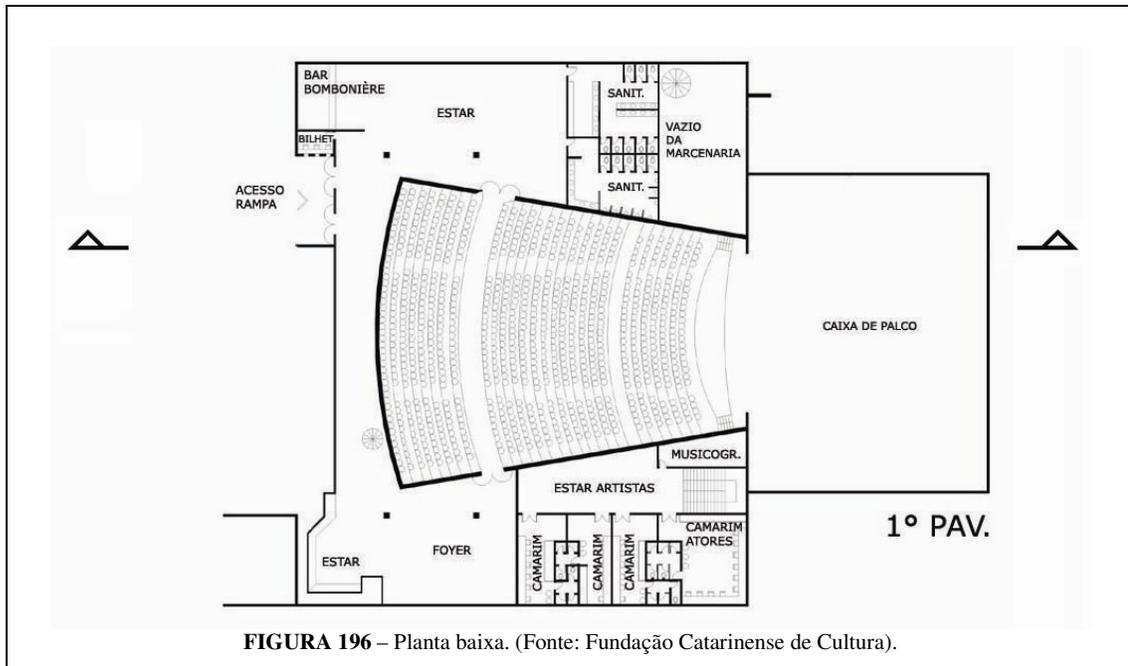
Planta baixa. (Fonte: Fundação Catarinense de Cultura).
